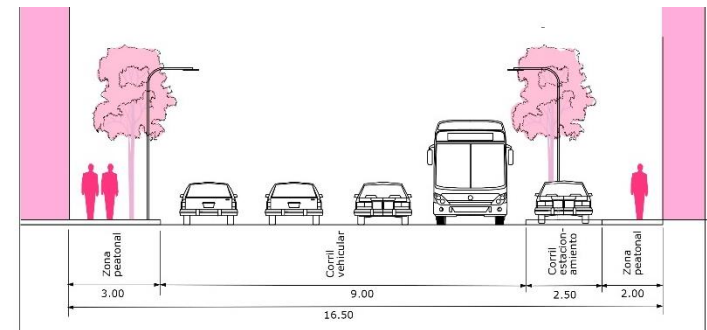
Perfil de acera calle Avenida central. Fuente: Elaboración propia
